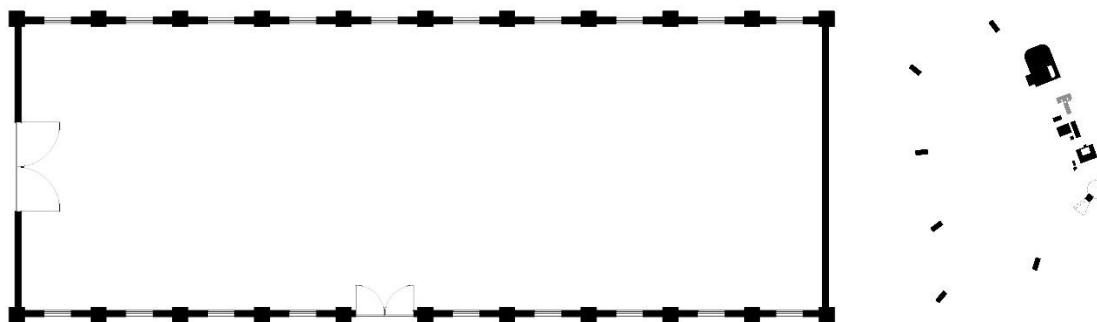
Planta do Armazém Agrícola – Existente
